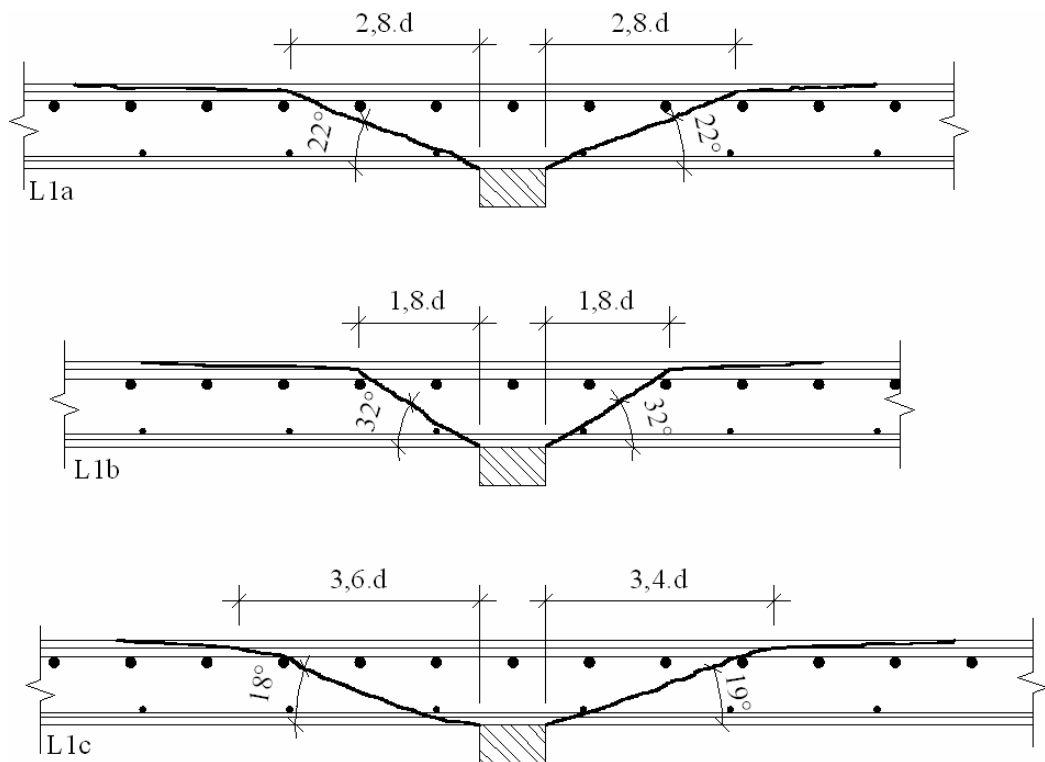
Inclinação do cone de ruptura na direção longitudinal das lajes na posição 1
